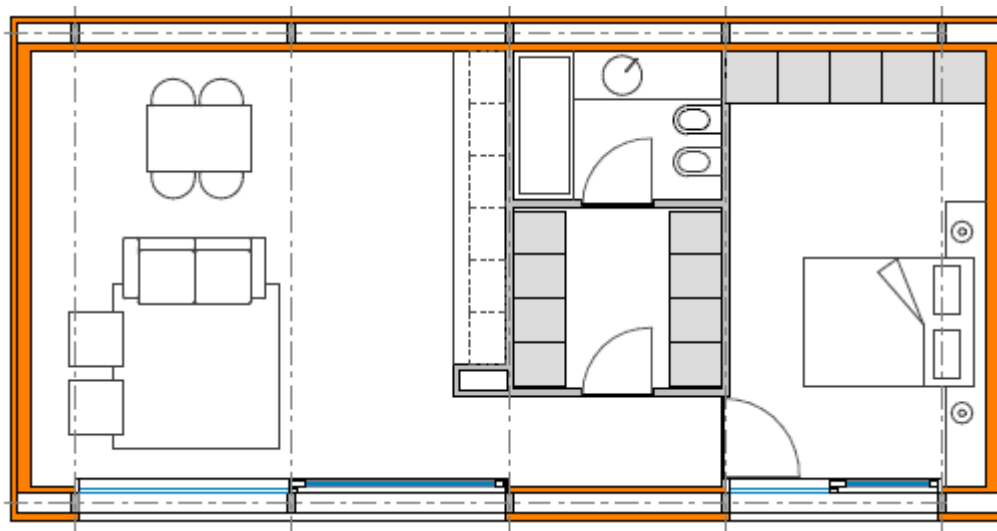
Planta do modelo T1 da MODULAR SYSTEM
